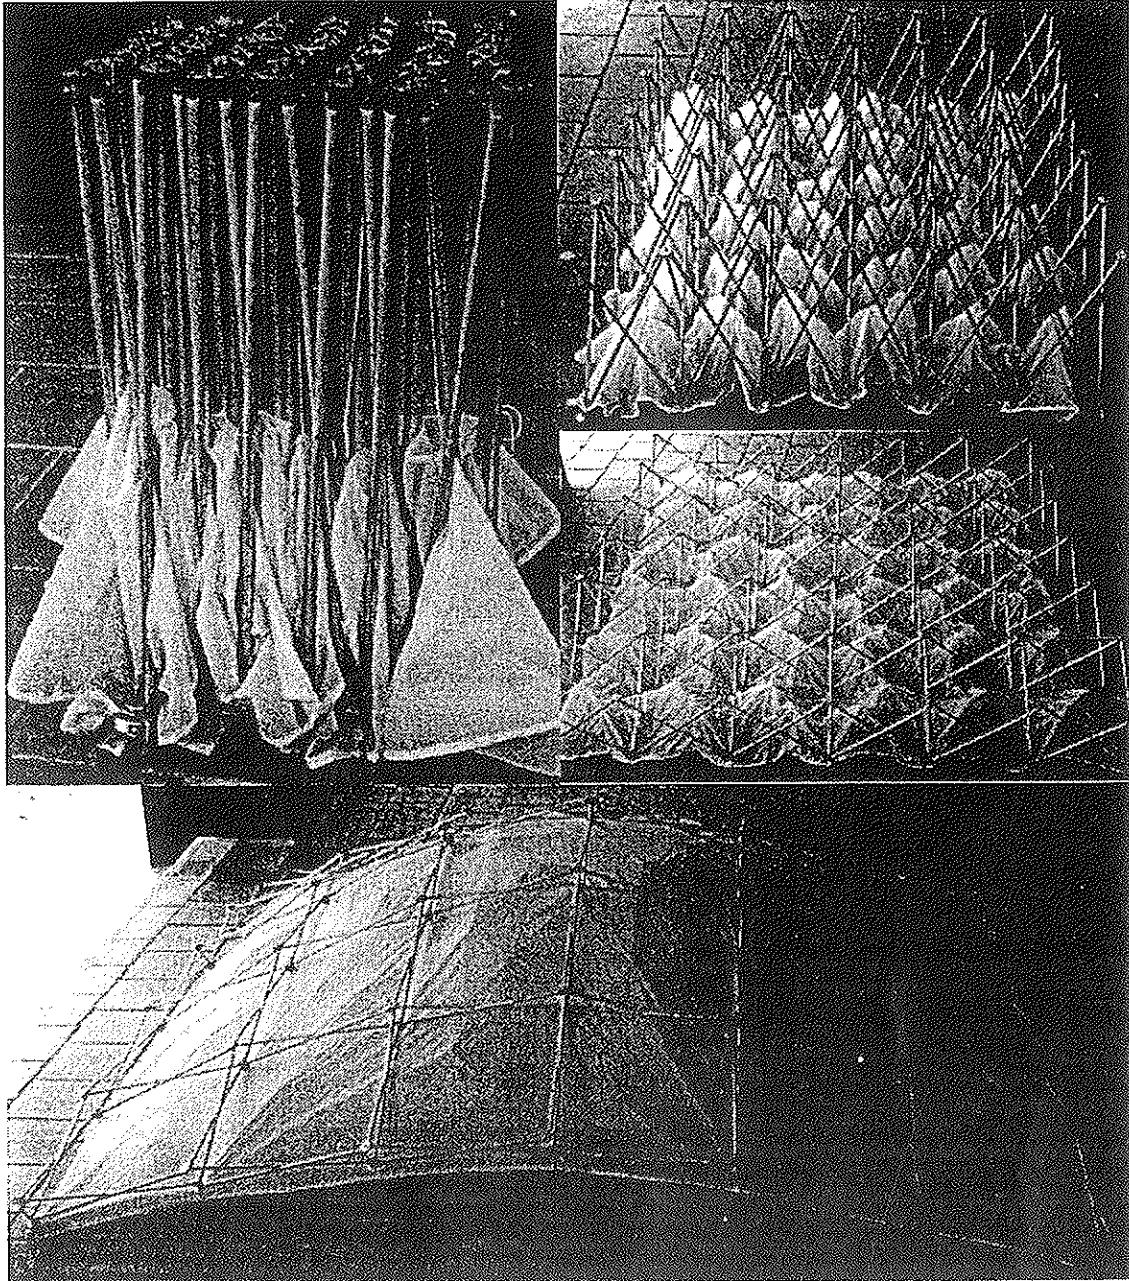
Modelo reducido, con textil en la cara inferior que se recoge hacia el interior con el plegado de la estructura.
